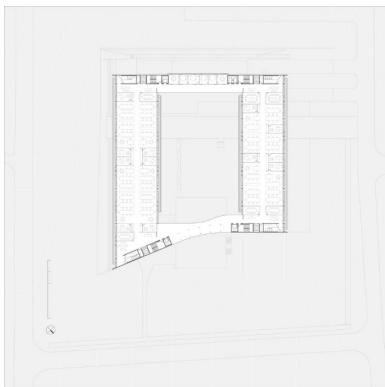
Primeiro pavimento sede do SEBRAE nacional, Brasília
